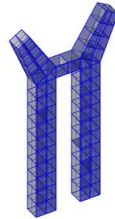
| Captura de SAP2000: Pilares interiores de hormigón armado. (elaboración propia)
